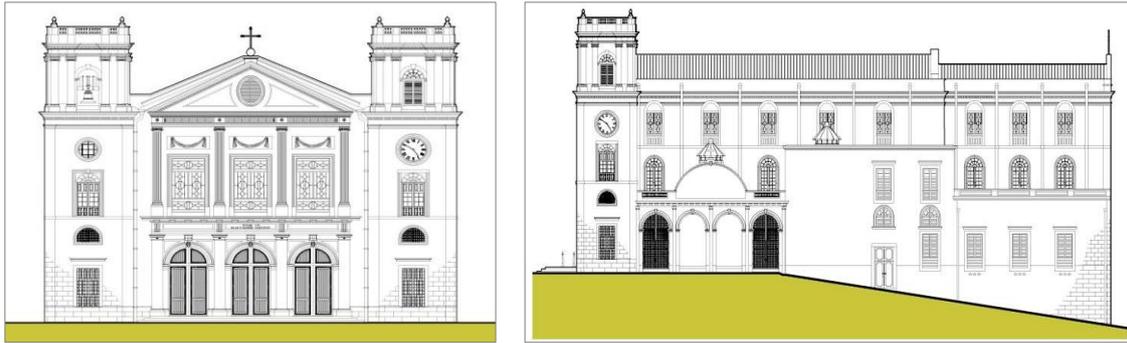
Alçado Frontal e Fachada Poente da Sé Catedral de Macau.
